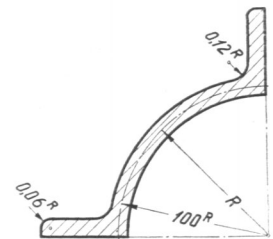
Quadranteisen mit 100 mm Halbmesser der Wandmitte und 12 mm Dicke der Rundung, 100 · 12.
